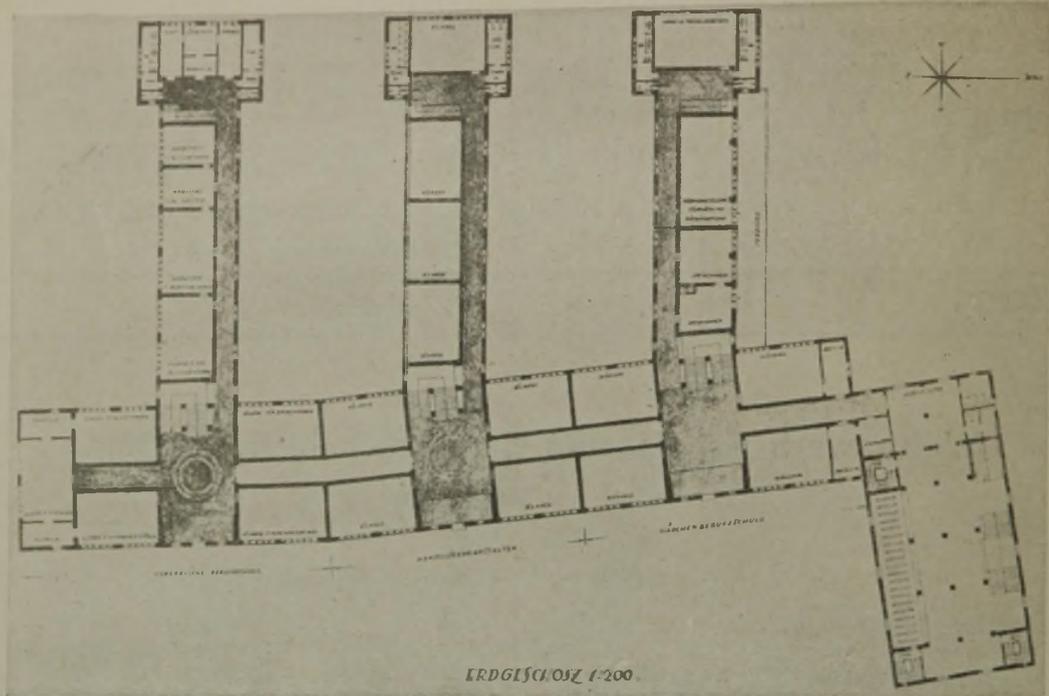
u. 3. Grundriß Erd- und Untergeschoß.
